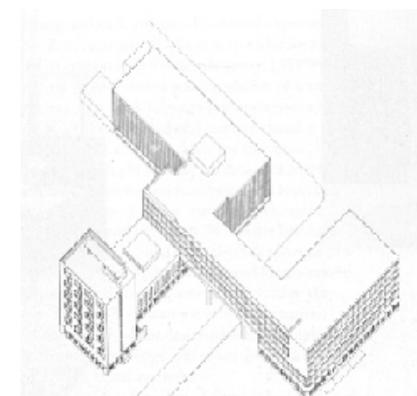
Walter Gropius, Edifício Bauhaus, projeção axonométrica, 1925 – 1926, Dessau.
